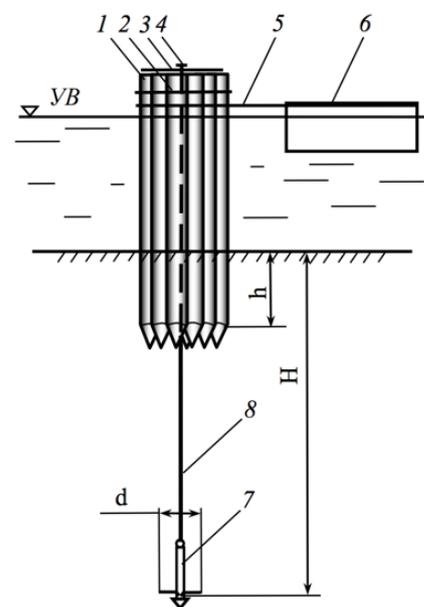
Свайный куст с якорной опорой: 1 – свая; 2 – проволочные обвязки; 3 – ограничитель; 4 – фиксатор; 5 – канат швартовый; 6 – плот; 7 – забивной якорь; 8 – шейма
